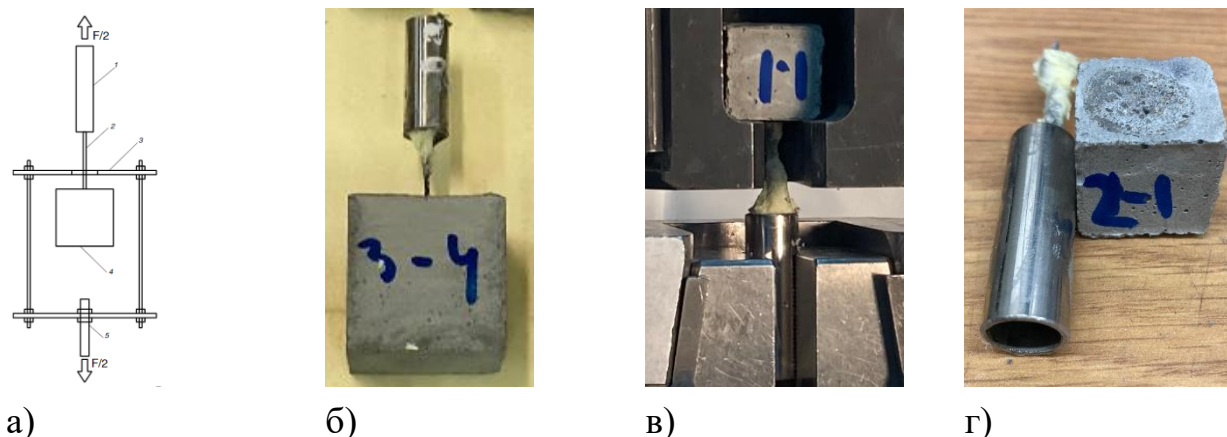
Испытание на вырыв из бетона: а – схема испытания [5], б – подготовленный образец, в – момент испытания, г – образец после испытания
